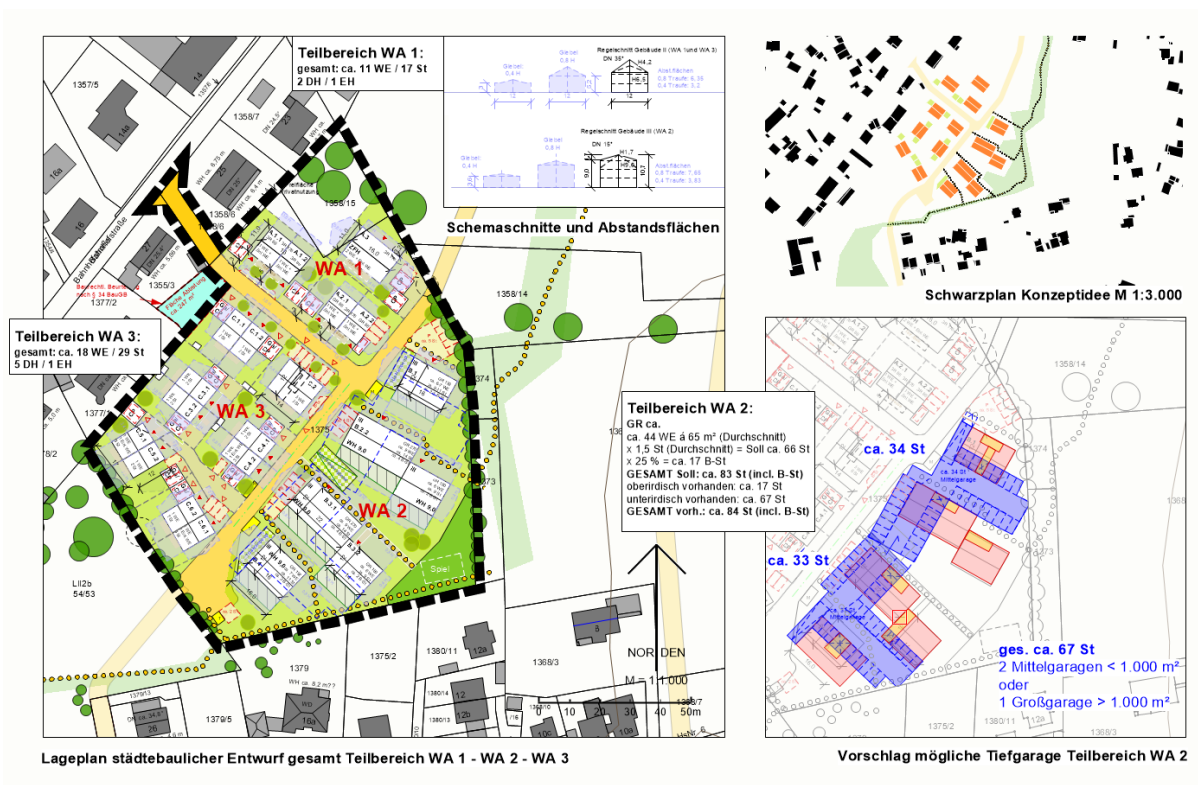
Städtebaulicher Entwurf mit Anordnungsvorschlag Tiefgarage bei Geschosswohnungsbau im Teilbereich B/WA 2 sowie Schwarzplan; Plandarstellung: PV; Stand: 09/2023
